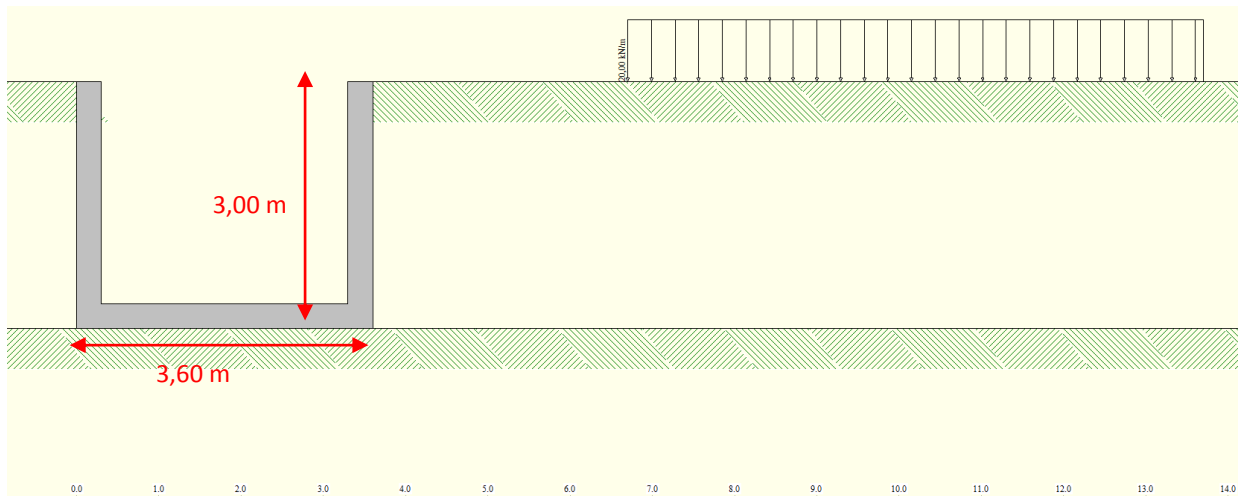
Schematizzazione della sezione di calcolo Pozzetto imbocco
